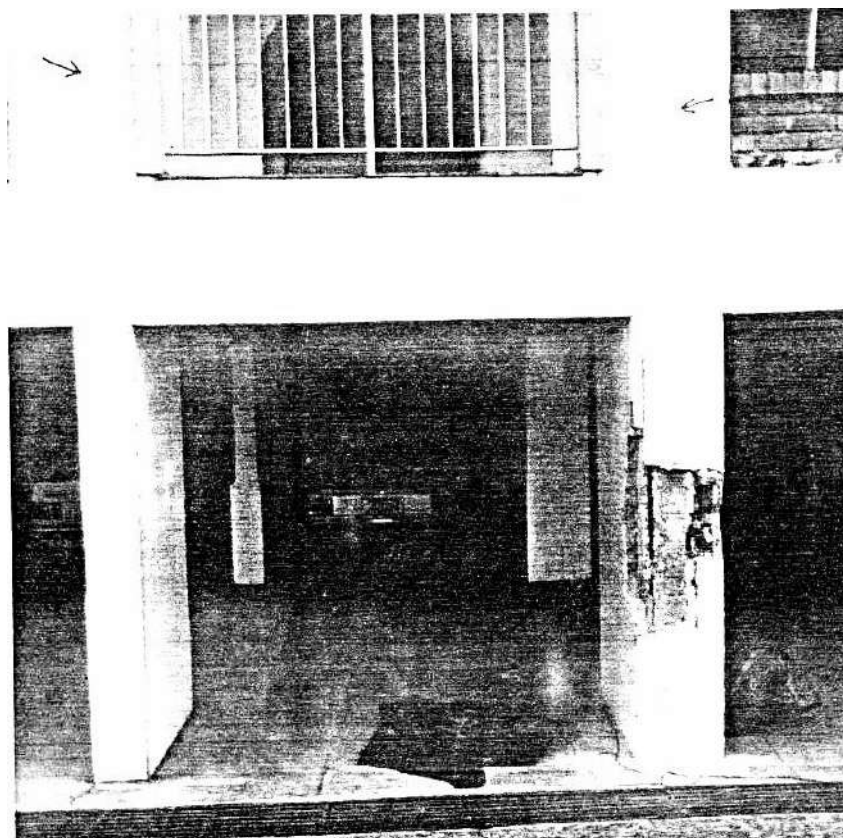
Um pilar de fachada deteriorado por corrosão das armações.
